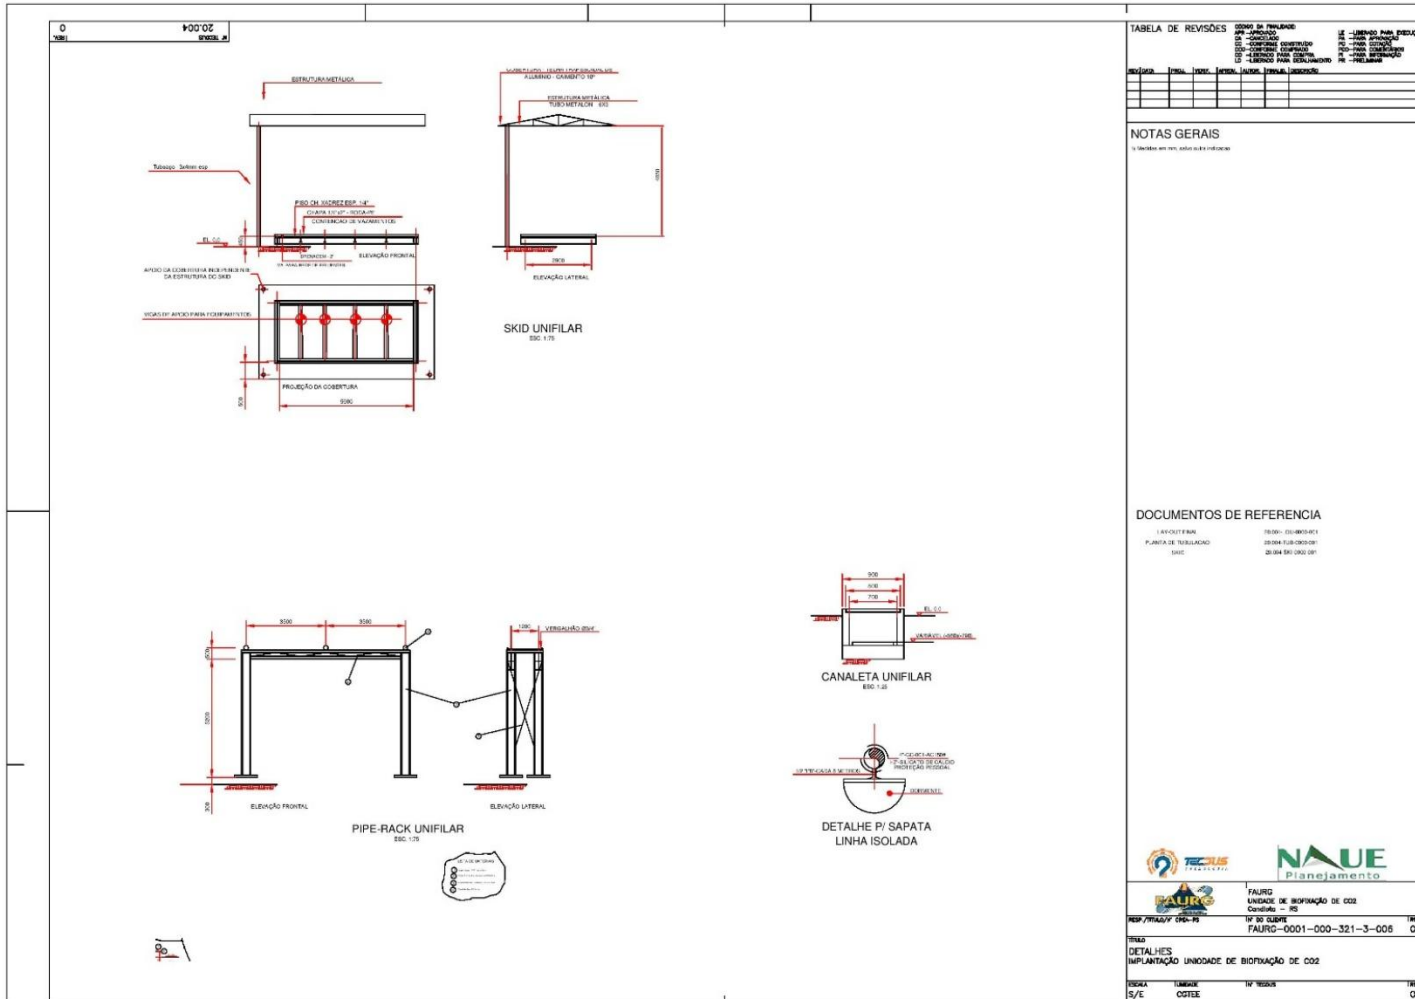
Construção do pipe-rack para passagem da tubulação de gás
